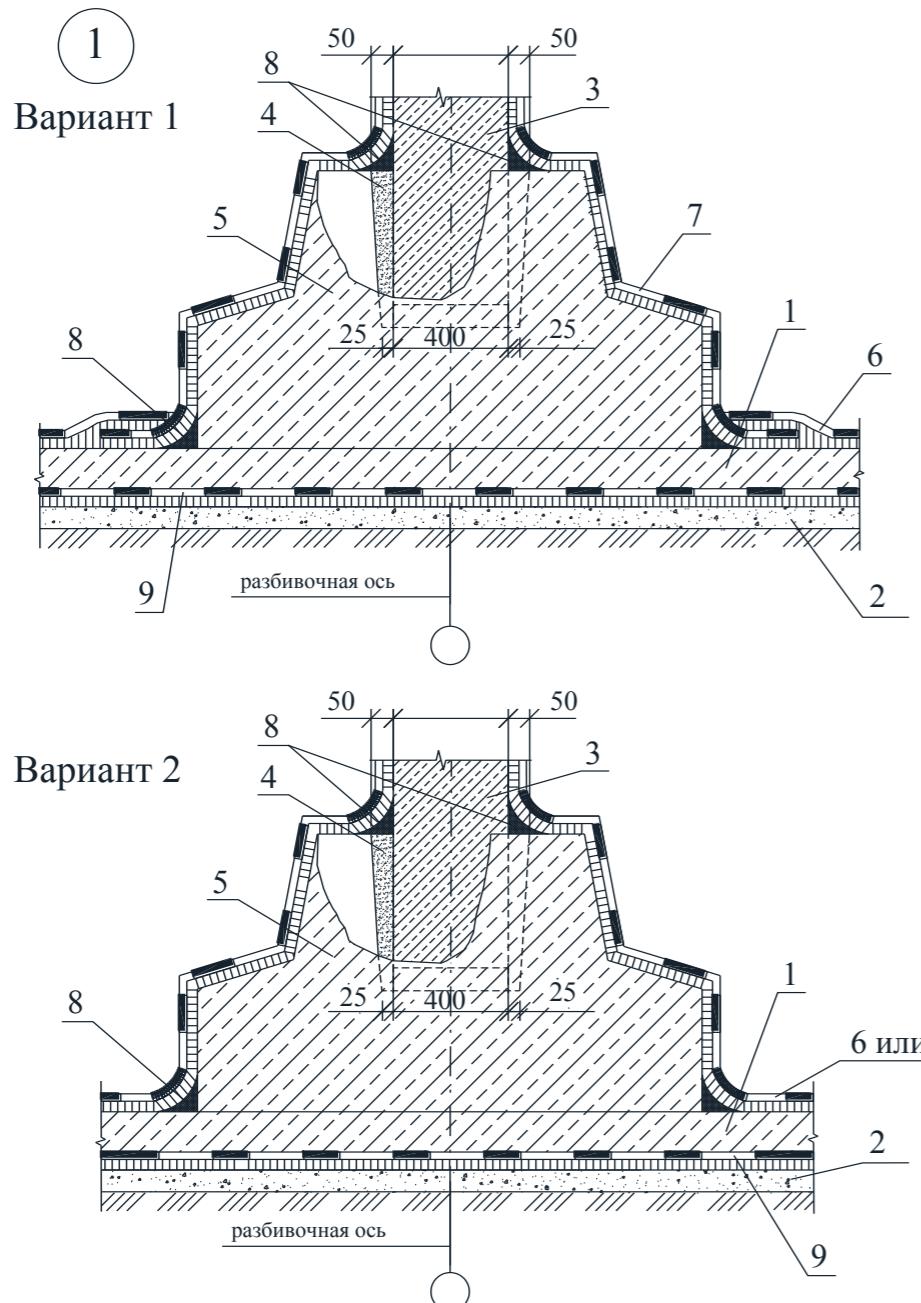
Узел 1. Сопряжение колонны с фундаментной плитой (варианты)
